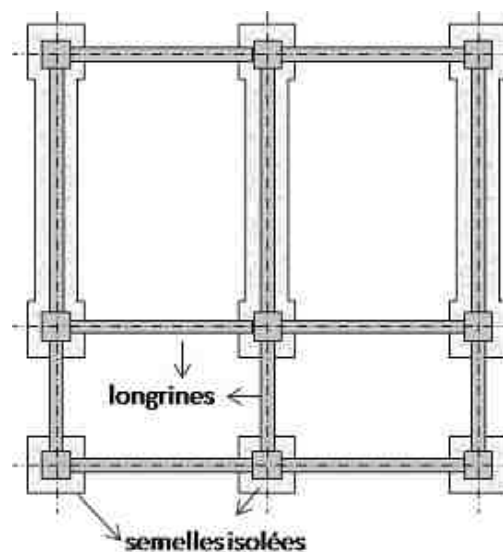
exemple de liaisonnement des fondations isolées par longrines
